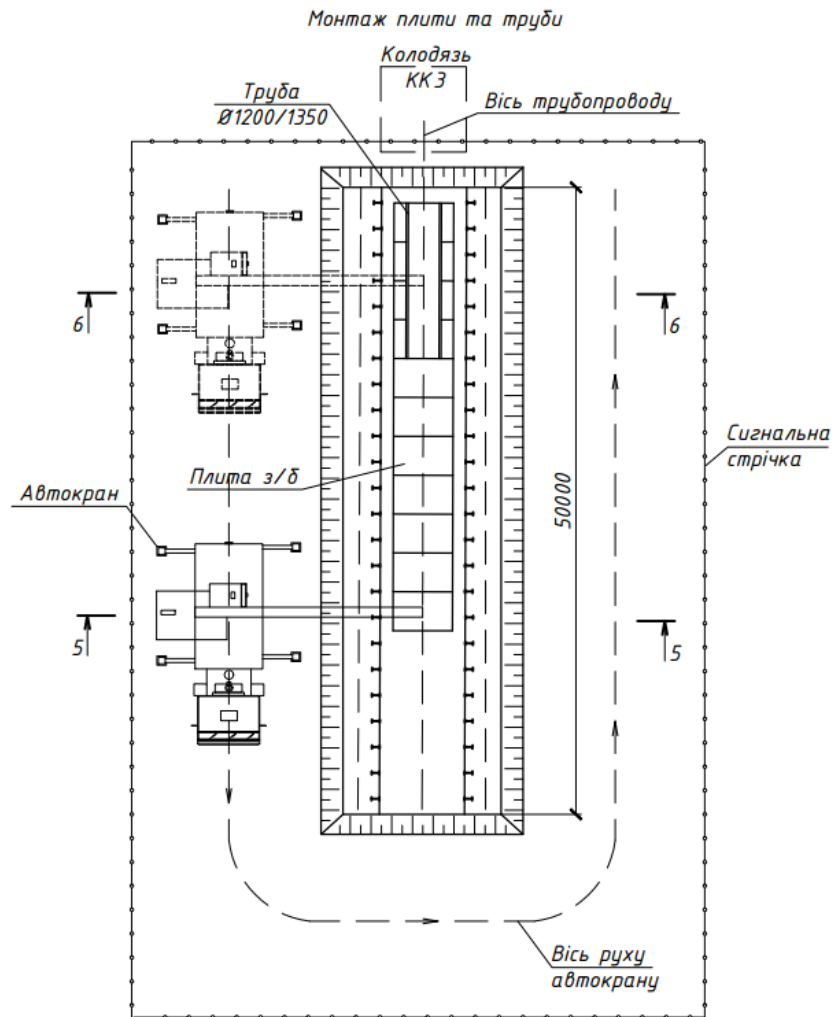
Схема монтажу з/б плит та труб.
